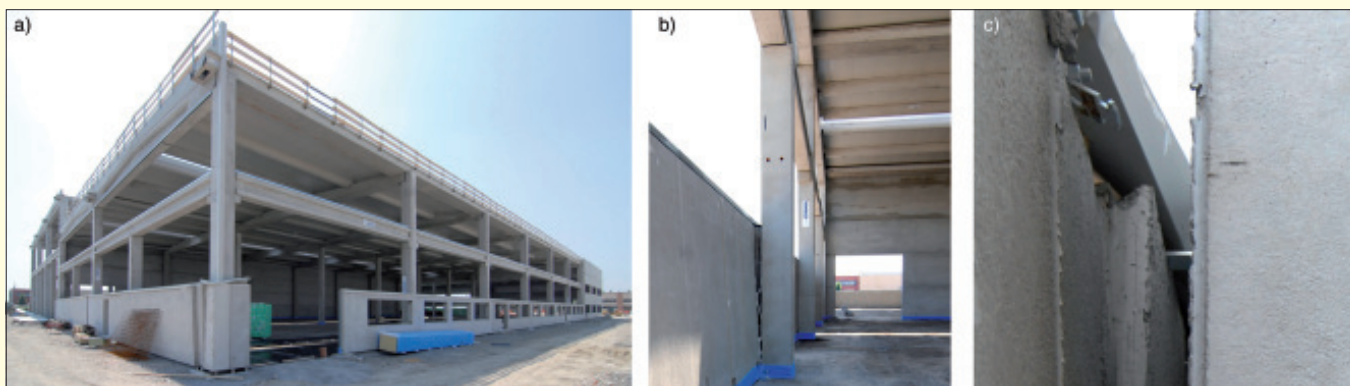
Neubau einer Lagerhalle aus Stahlbeton-Fertigteilen in Cavezzo. Innenansicht einer nach außen gekippten Fassadenplatte (b) der Querfassade in der Ansicht (a). Detailansicht des herausgerissenen Fassadenankers (c).
